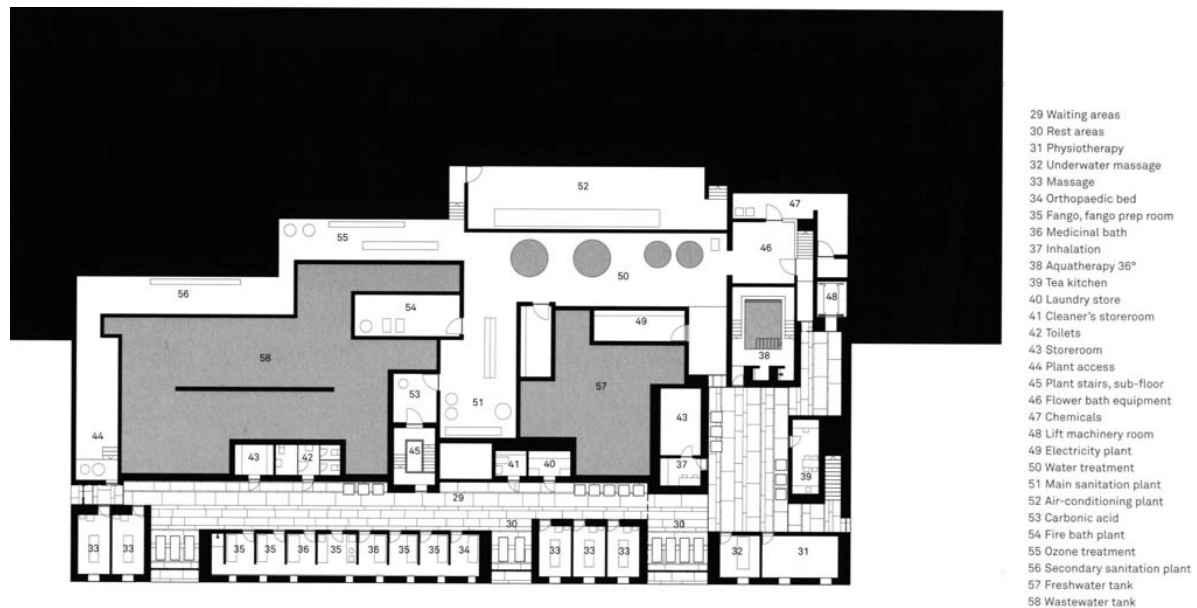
Planta do piso inferior. Reproduzido de Zumthor, 2008:96.
